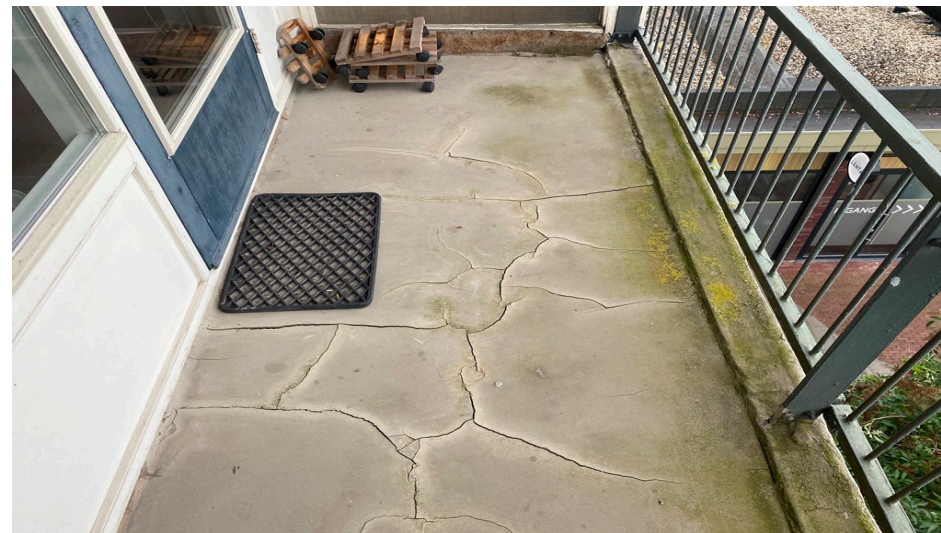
Scheuren, onthechtingen en vervuiling van de bestaande afwerking. Deze bestaande onbekende dickere coating beschermt de constructie onvoldoende.
